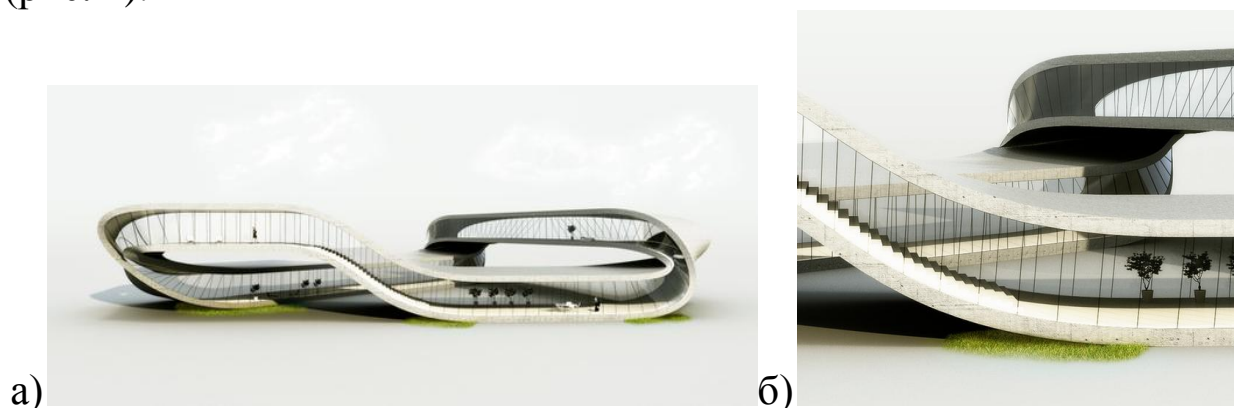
Проект The Landscape House [1]: а – вид здания; б – конструкция этажа
